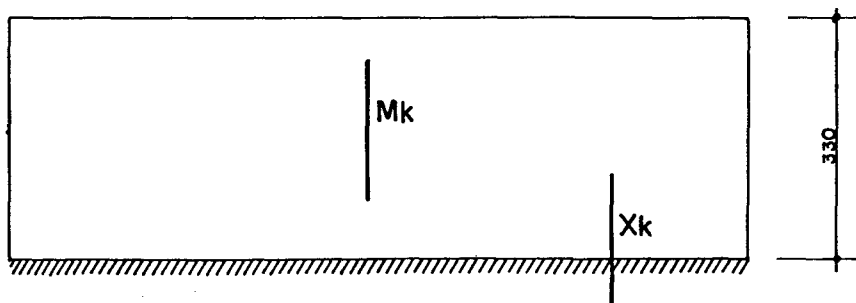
CARACTERÍSTICAS DA LAJE
